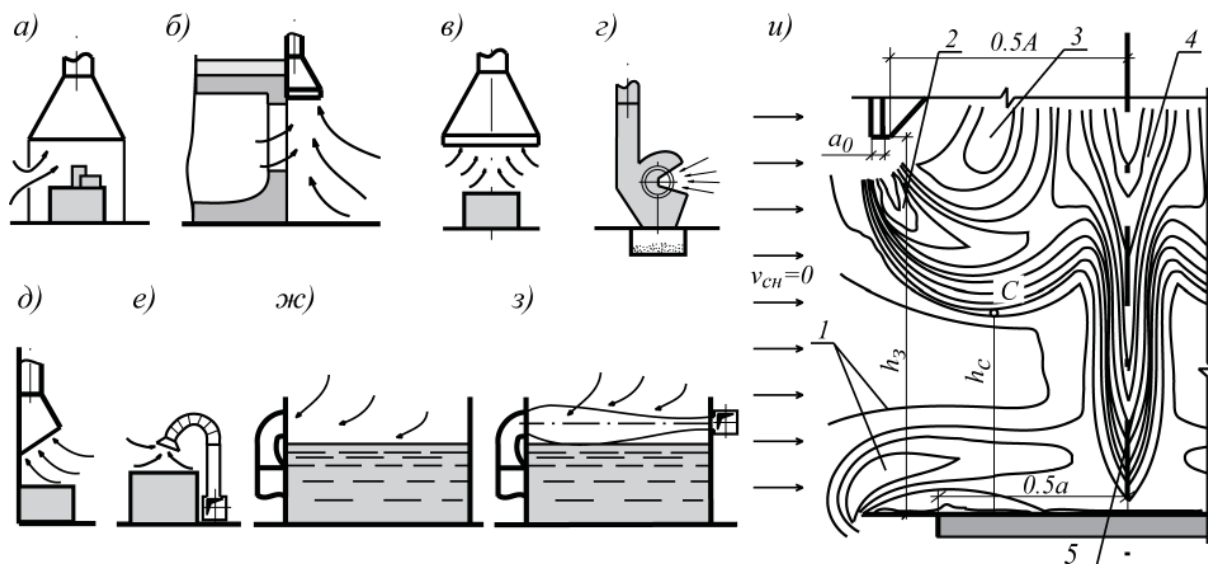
Основные конструкции местных отсосов: а – вытяжной шкаф; б – зонтик над загрузочным проемом печи; в – индивидуальный вытяжной зонтик; г – отсос укрытие над шлифовальным кругом; д – сварочная панель у стационарного поста сварки; е – гибкий поворотный воздухоприемник; ж – односторонний бортовой отсос; з – бортовой отсос с передувом; и – линии токов при трёхпоточном взаимодействии источника теплоты, стока (спектра всасывания) и приточной струи; 1 – подсасываемый поток воздуха, 2 – траектория приточной струи, засасываемой вытяжным факелом, 3 – область обратного потока, 4 – вытяжной факел, 5 – конвективный поток [70, 71]
